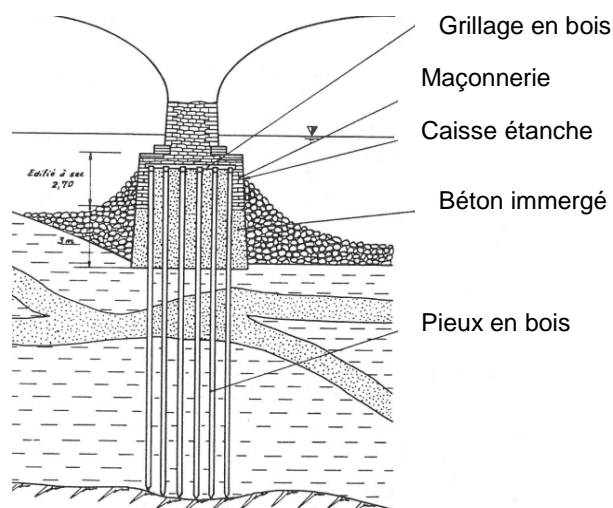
Fondations du pont de la Morinière (modifié d'après [Levillain, 1980](#))
